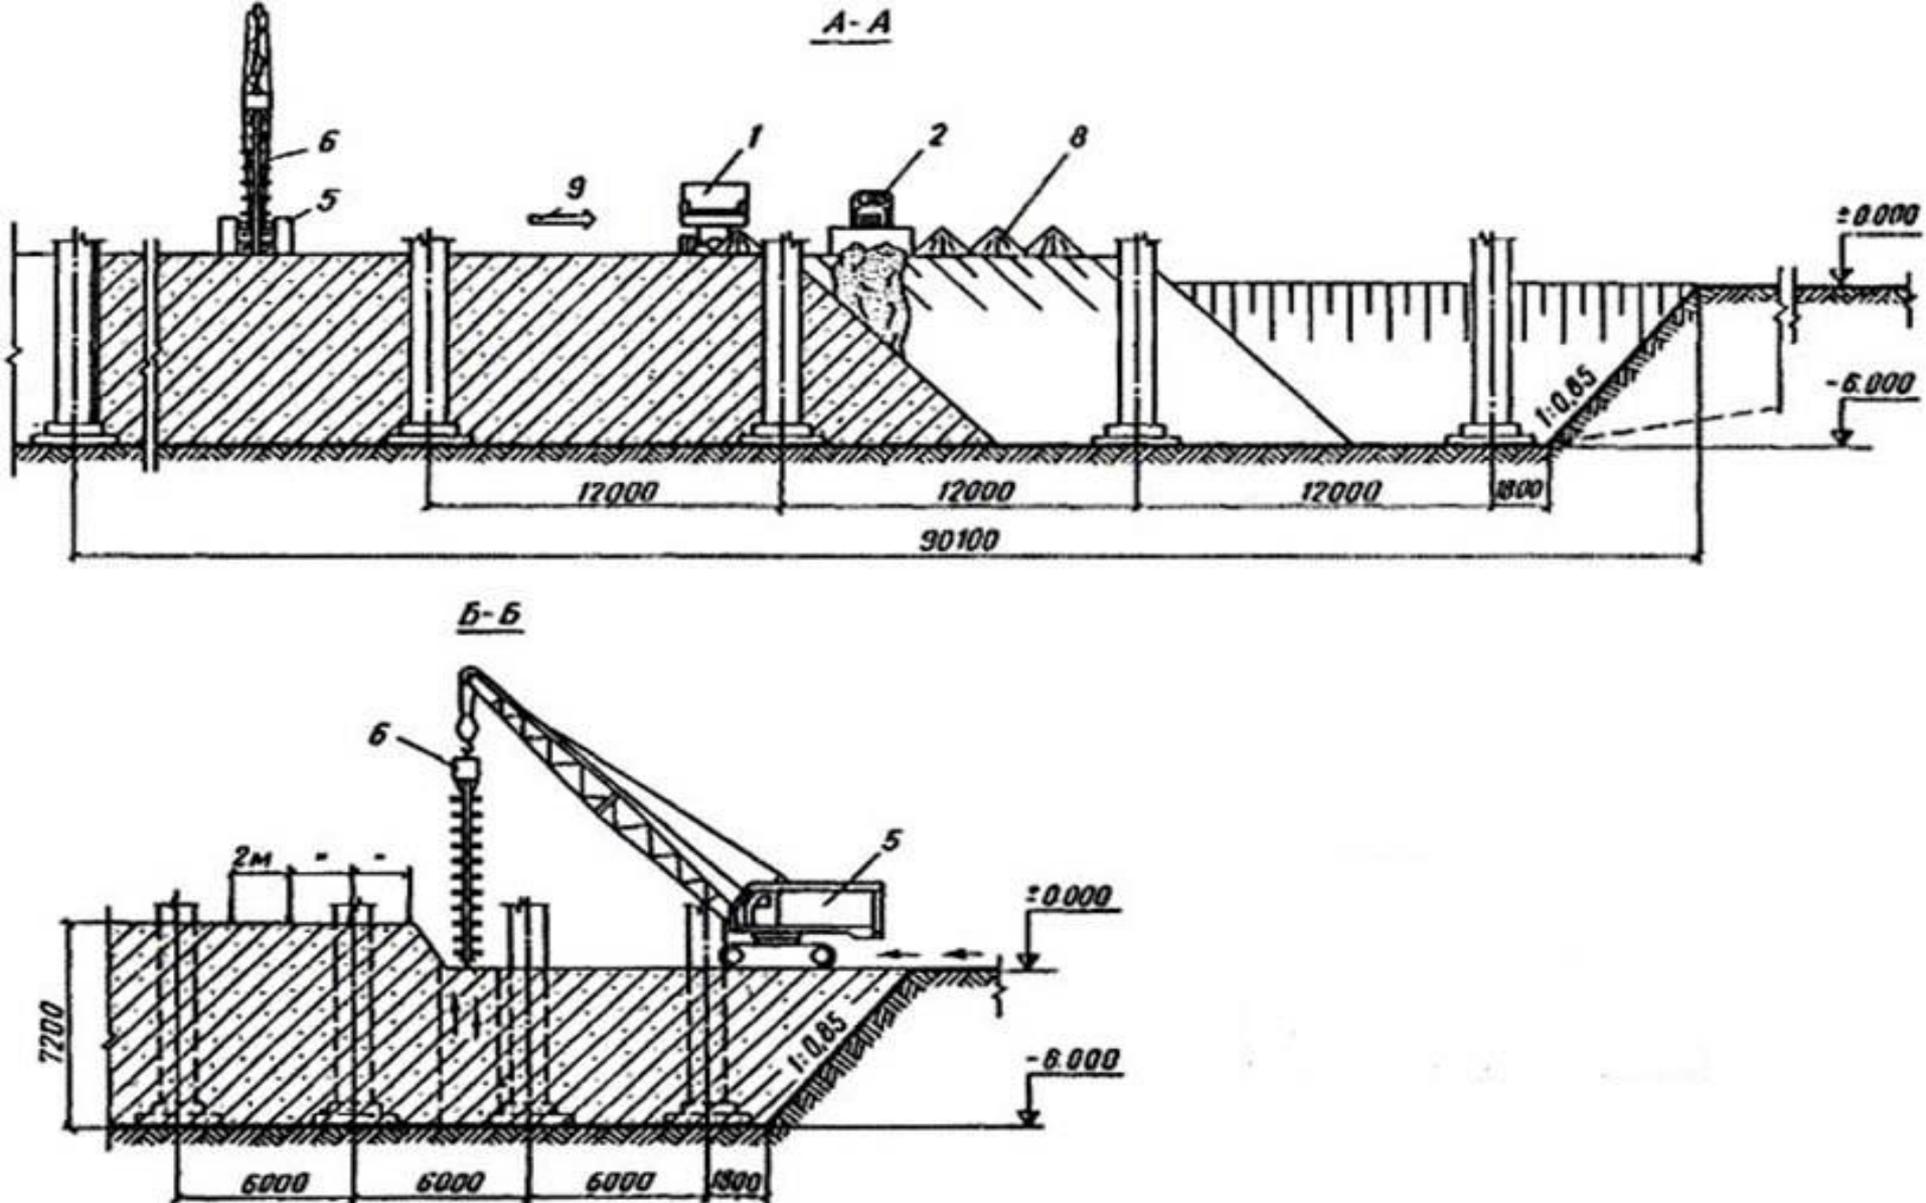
Схема обратной засыпки несвязным грунтом котлована с установленными колоннами:
